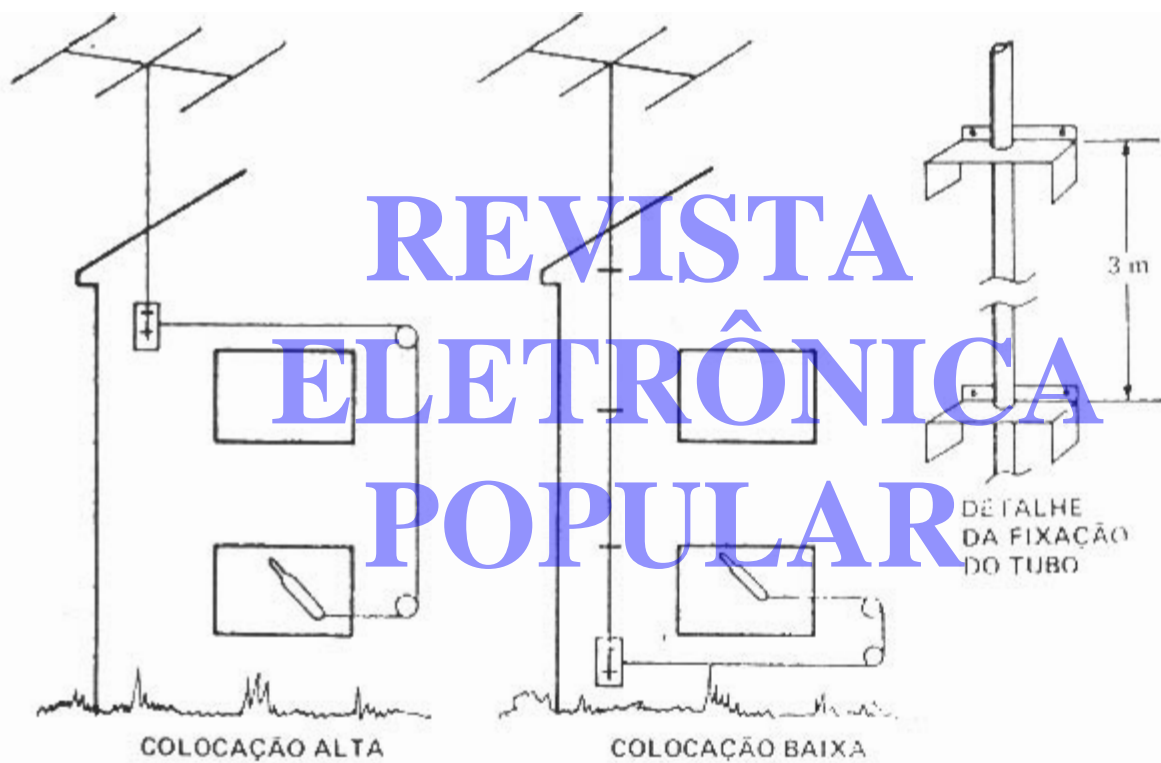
O rotor pode ser fixado no alto, próximo à antena, ou então embaixo, sendo ligado à antena por intermédio de um tubo de extensão. Em detalhe, vemos como esse tubo é fixado à parede externa do prédio.
